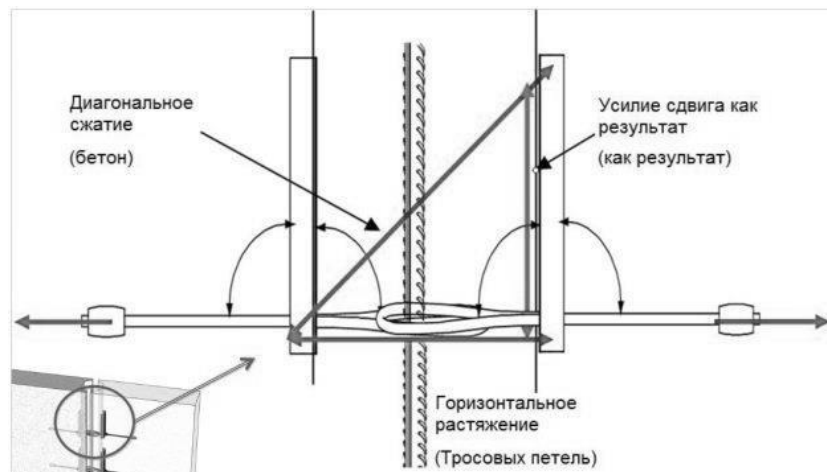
Армирование нахлеста вертикального стыка стеновых панелей.
